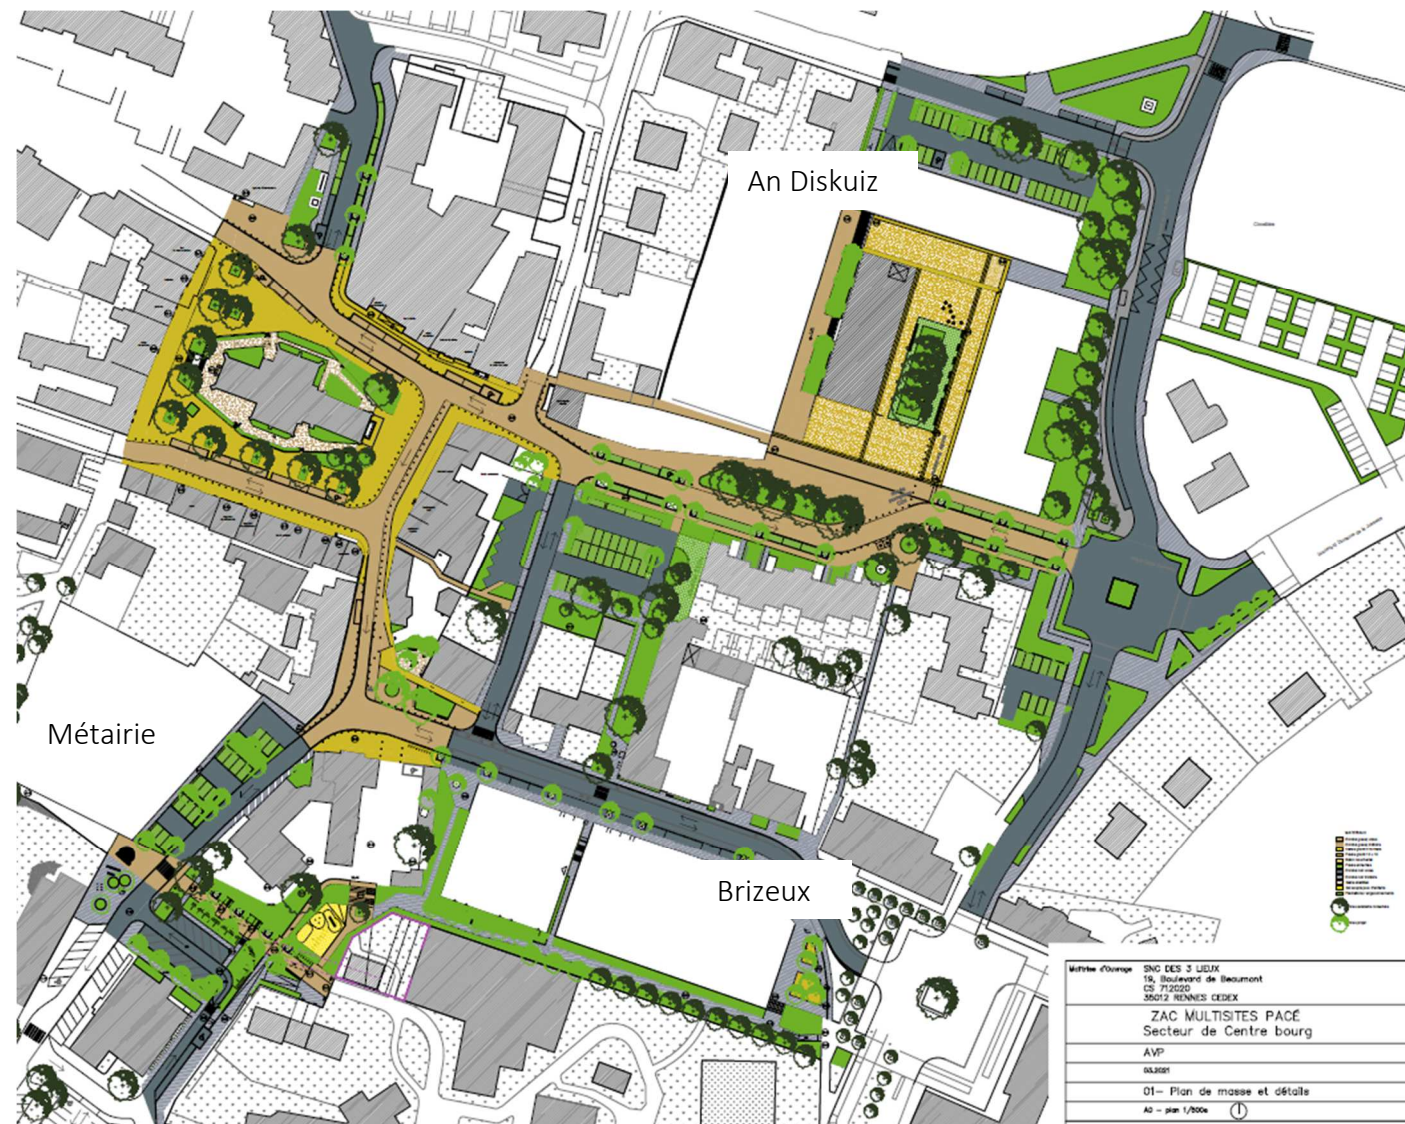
Plan masse du renouvellement urbain du secteur Centre-bourg au stade AVP - Atelier Madec / La Plage Architecture et Paysage, 2022
